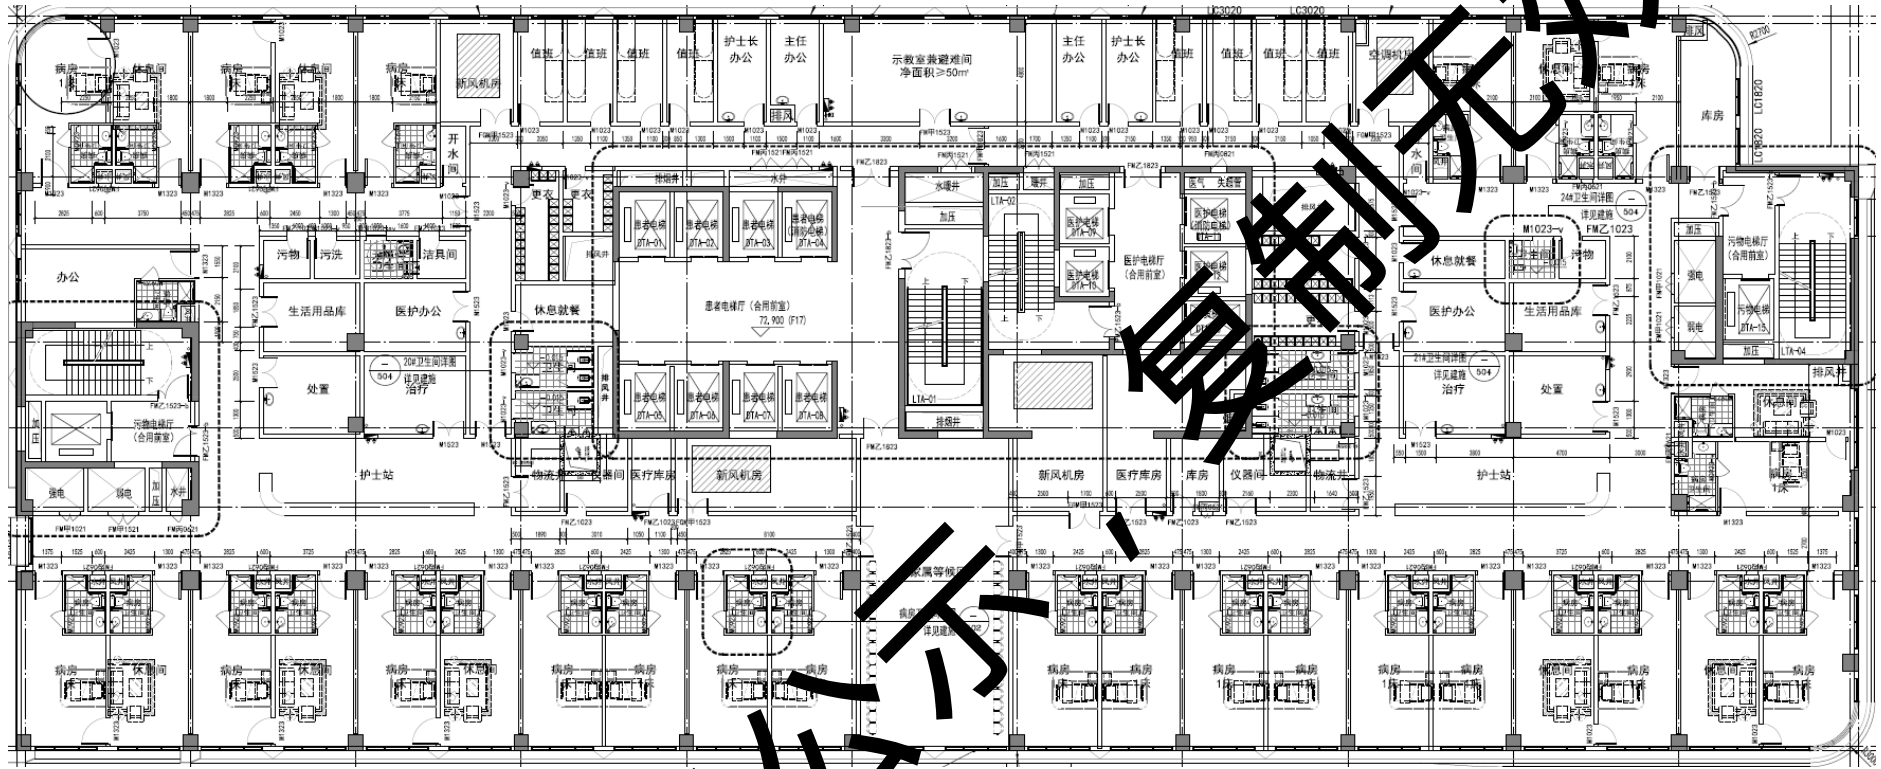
本项目新建住院综合楼 17F 平面布置图
